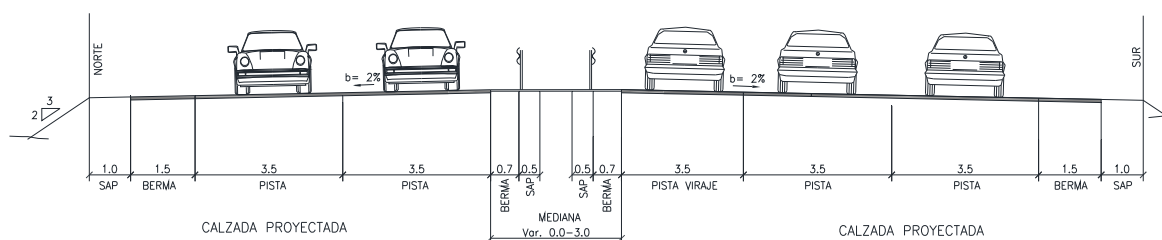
PERFIL TIPO RUTA 21
